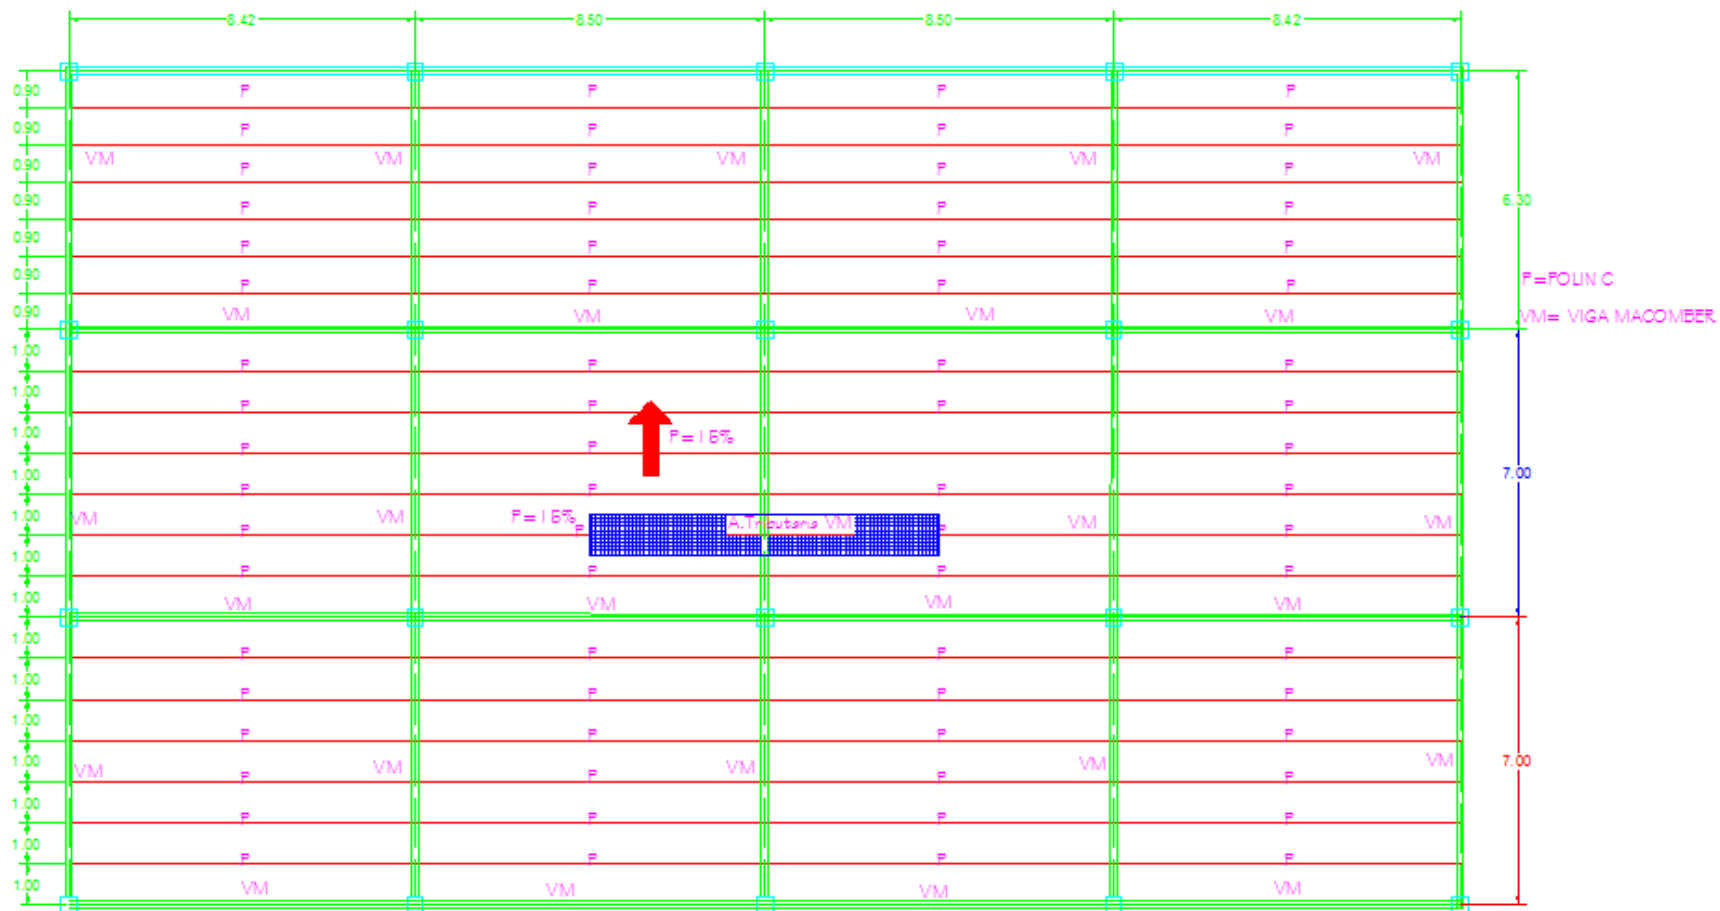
Vista en planta de carga tributaria transmitida del polin "c" viga macomber.
